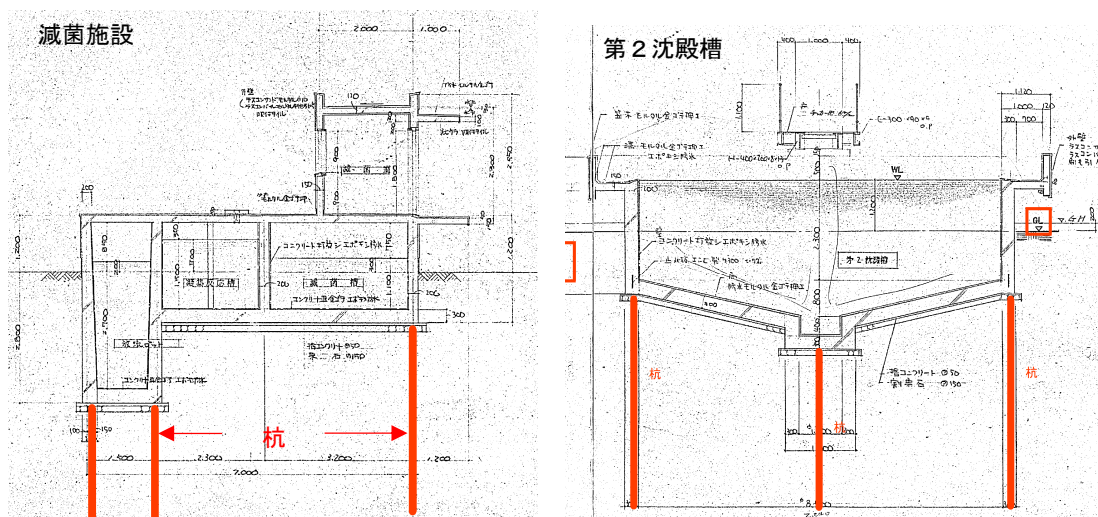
旧既設構造物の基礎配置図 ●：ボーリング地点
